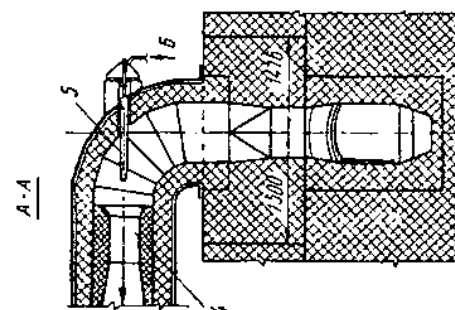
Поперечный разрез зоны охлаждения туннельной печи:
